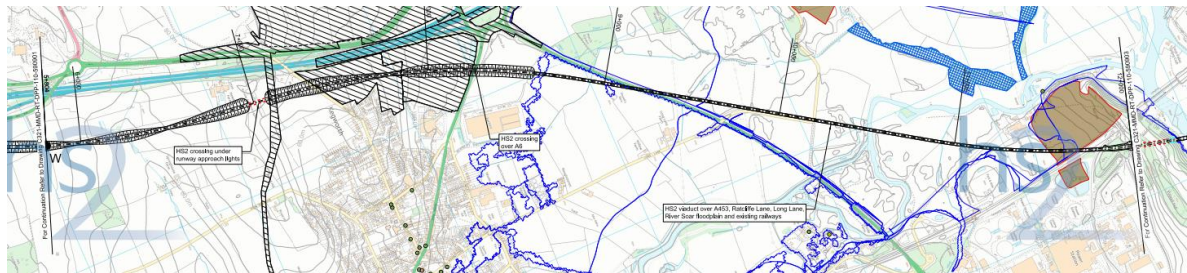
Planta do traçado viaduto sobre A453 e Ratcliffe Lane (Unido, HS2 Phase 2b: Tonge to Long Eaton route sheet 1).
